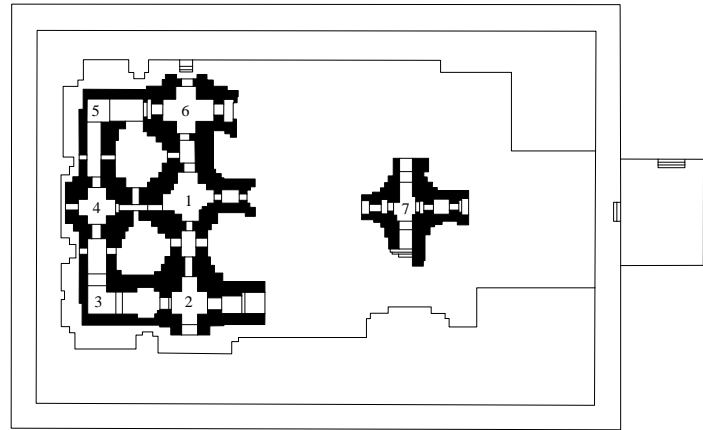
Plan d'ensemble du monument n°2
